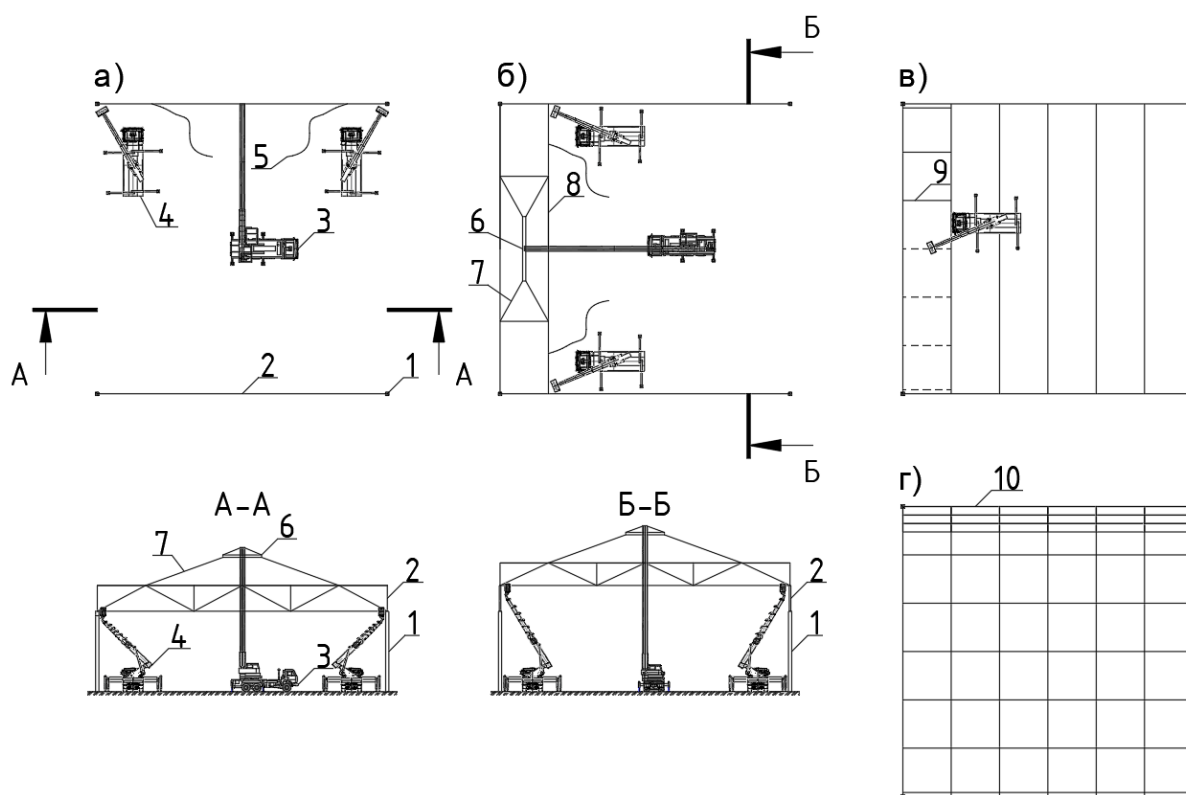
Укрупнительная сборка на уровне земли и монтаж конструкций в виде пространственного блока: а – монтаж подстропильных ферм; б – монтаж пространственных блоков; в – монтаж прогонов; г – монтаж стального профилированного листа; 1 – колонна; 2 – подстропильная ферма; 3 – автомобильный кран; 4 - подъемник; 5 – оттяжка; 6 – траверса; 7 – строп; 8 – пространственный блок; 9 – прогон; 10 – профилированный лист
